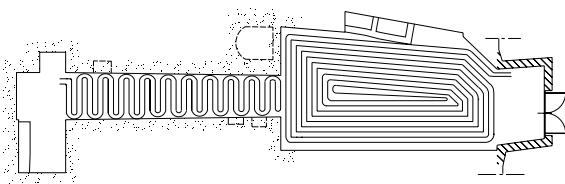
disposizione delle tubazioni per il riscaldamento a pavimento
